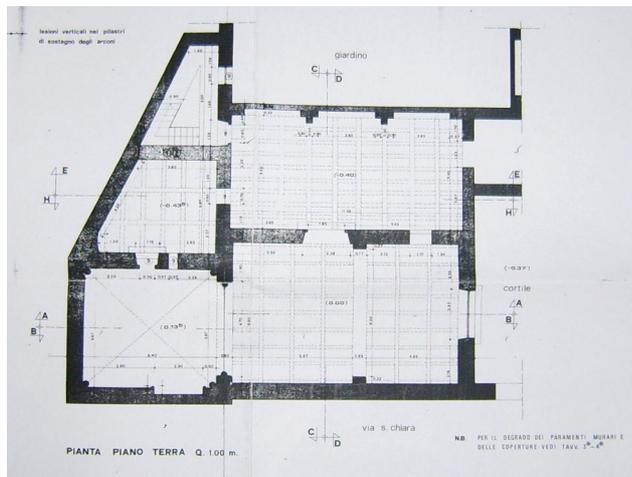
, Nola, Santa Maria Jacobi, planimetria del pianterreno in un rilievo degli anni Quaranta del Novecento (Napoli, Soprintendenza BAPSAE, Archivio Storico, F 38).
